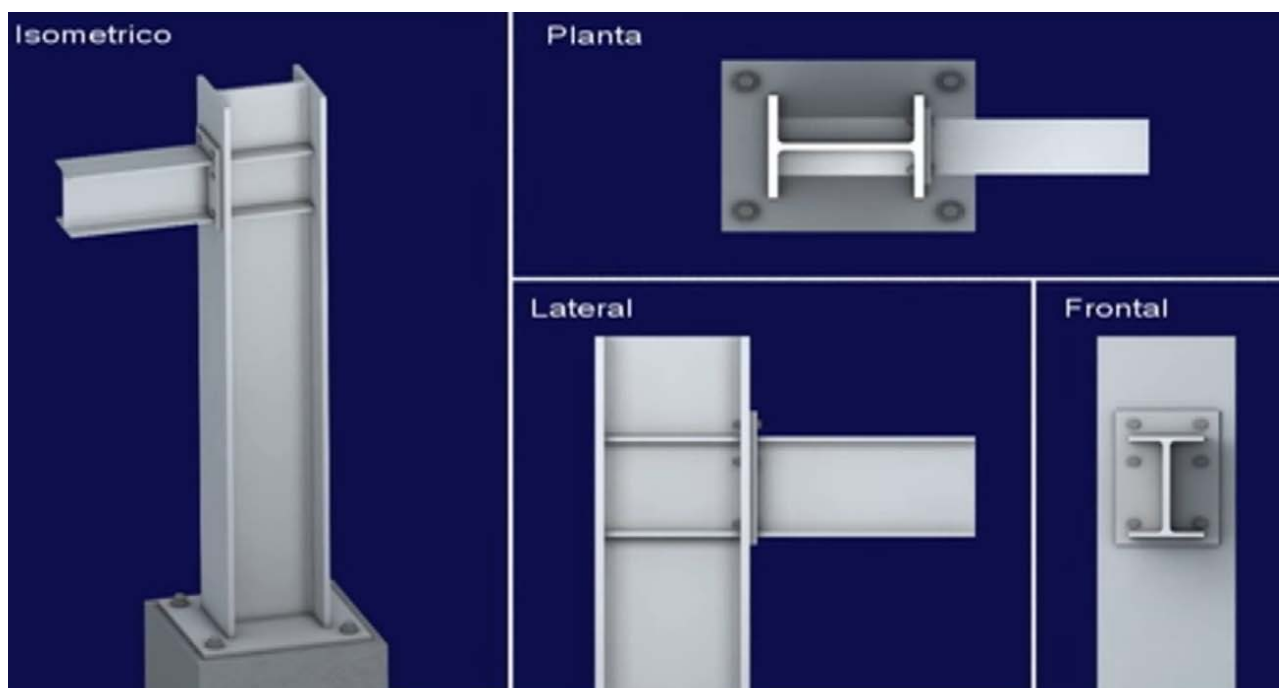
Vista isométrica, de planta, lateral y frontal de una conexión viga-columna rígida con placa de extremo.
